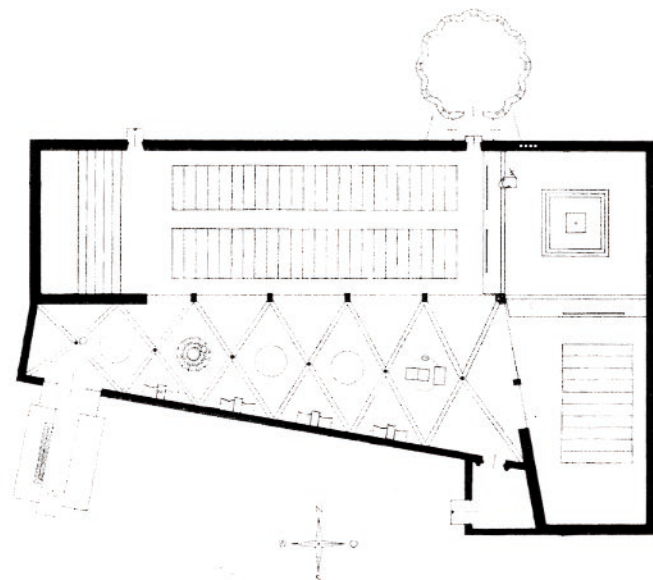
St. Anna in Düren, 1951 – 1956, Grundriss, Schnitt, aus: R. S., Kirchenbau S. 224
